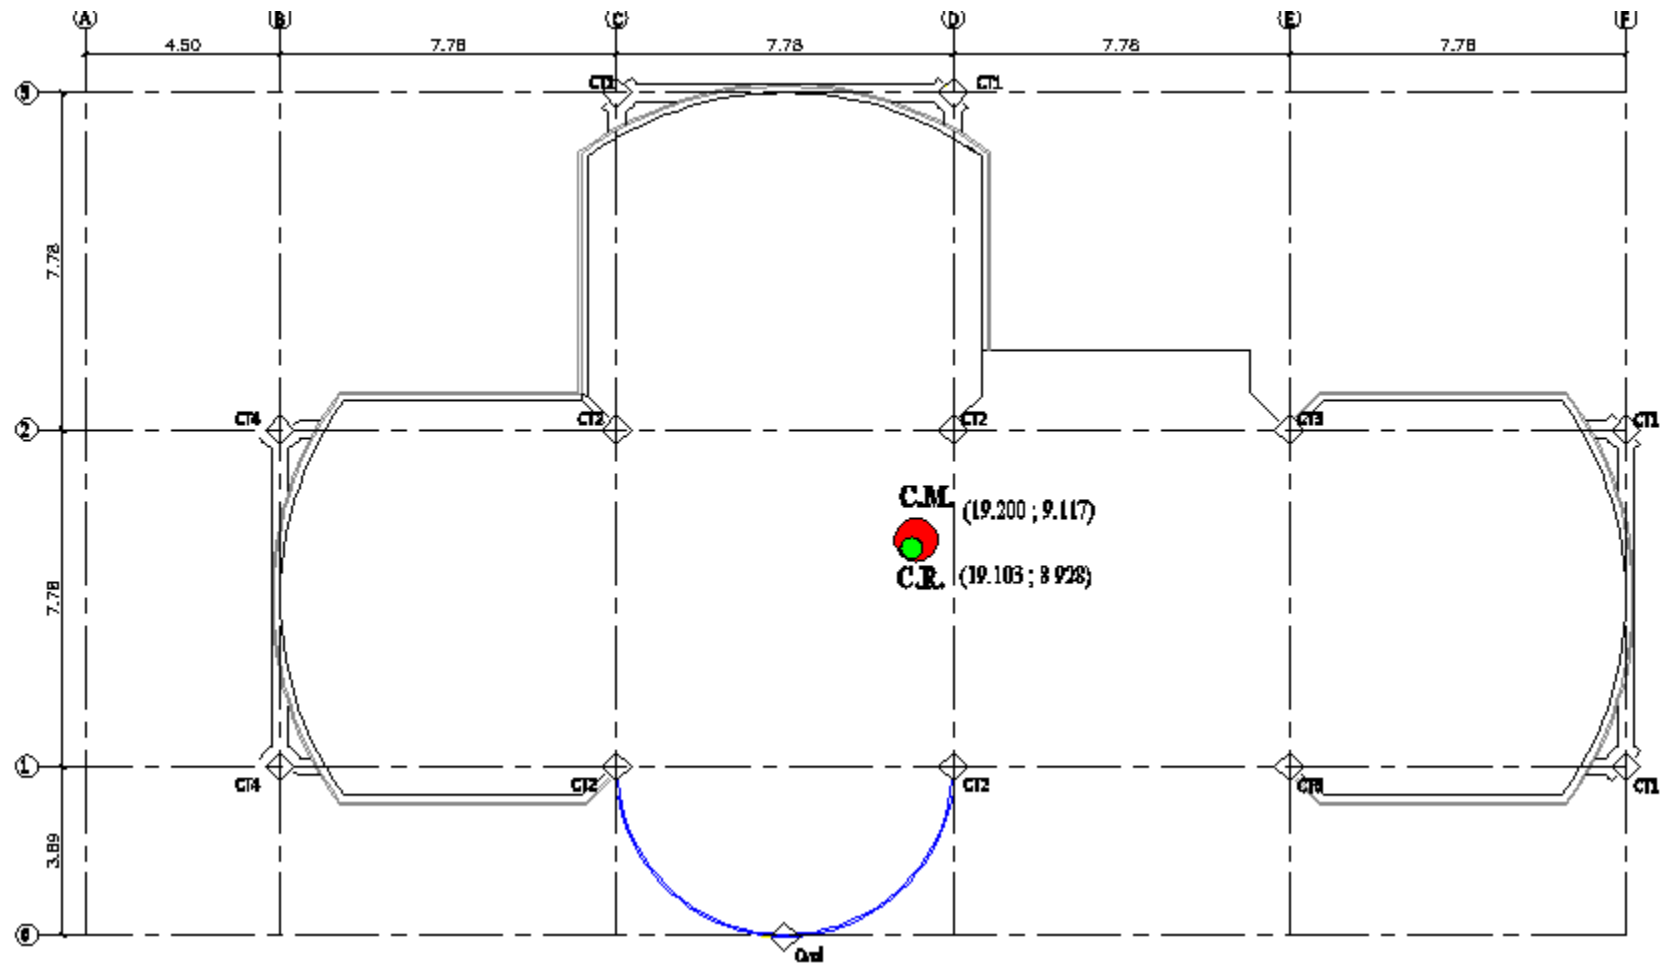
Centro de masas y rigidez de las losas N+5.96, N+8.84
